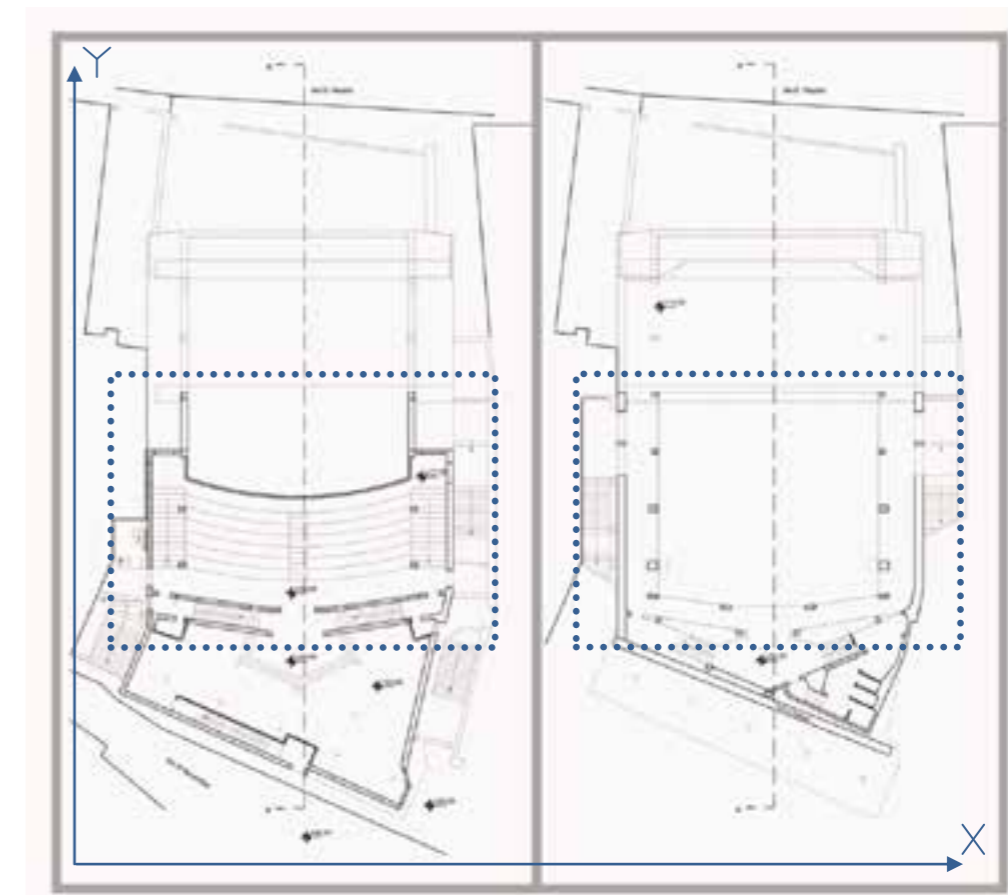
Pianta Atrio-Galleria q:+20.58/+17.70; Pianta Platea q:+15.43/+13.30
